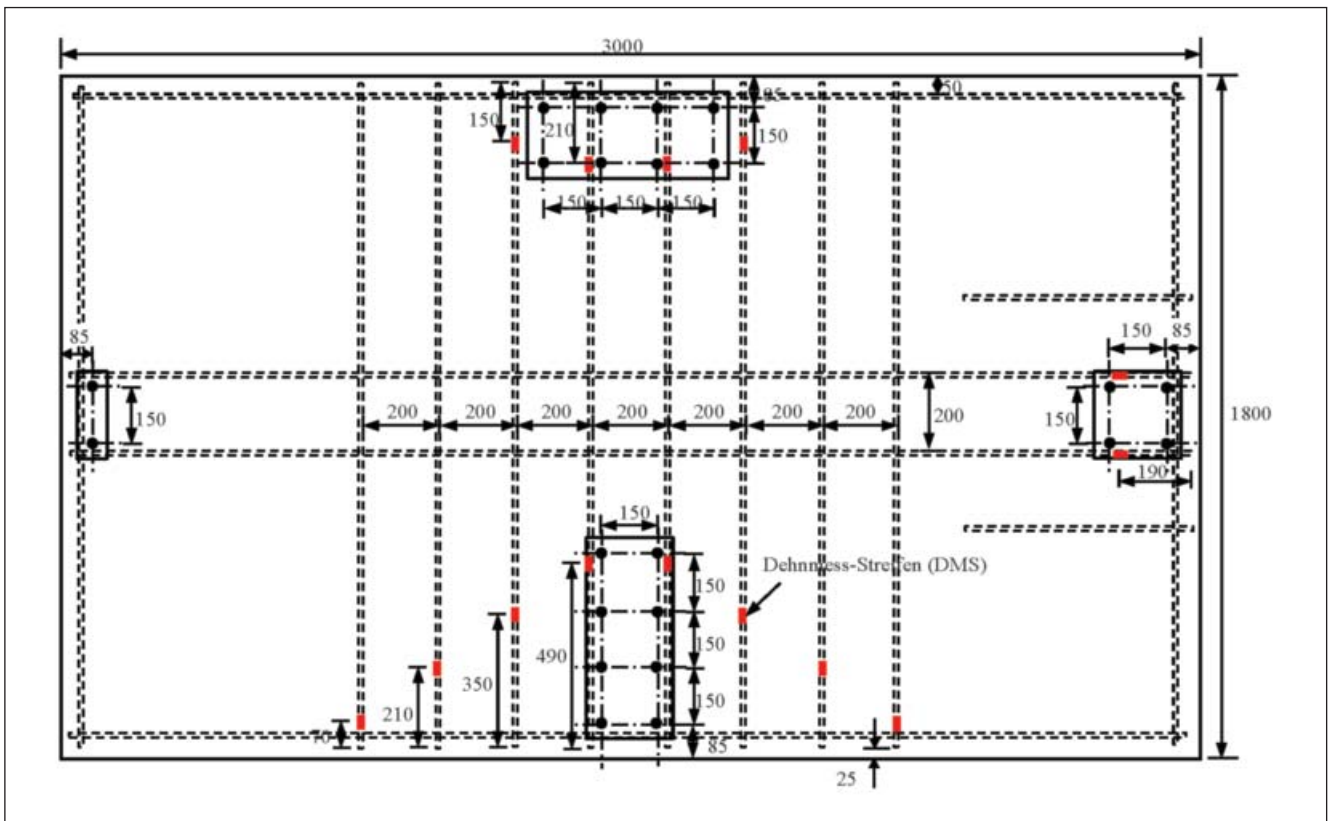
Versuchskörper mit Ankerplatten, Bügel und Randbewehrung aus gerippten Bewehrungsstäben $\phi = 12$ mm sowie Lage der Dehnmessstreifen
